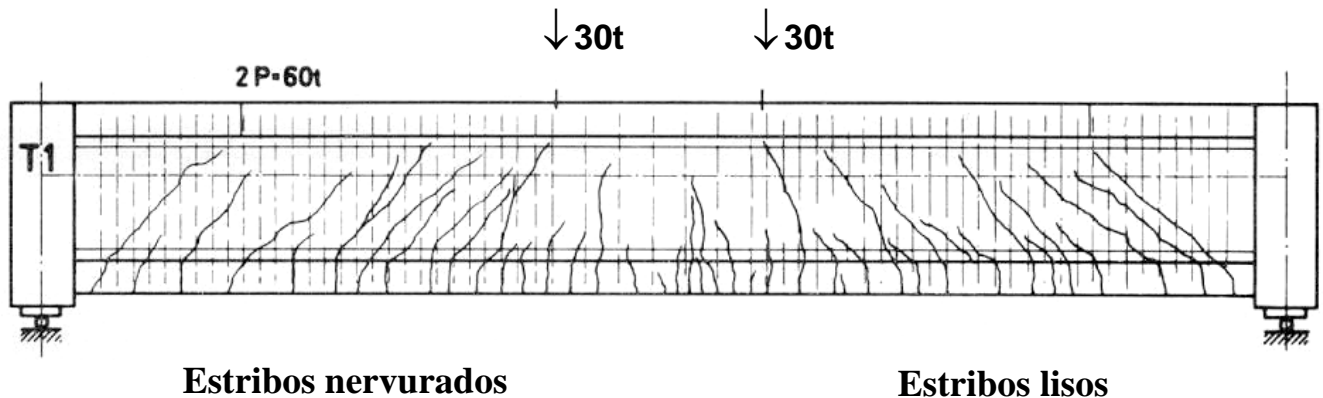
Fissuração para a carga total de 60t = 600kN
